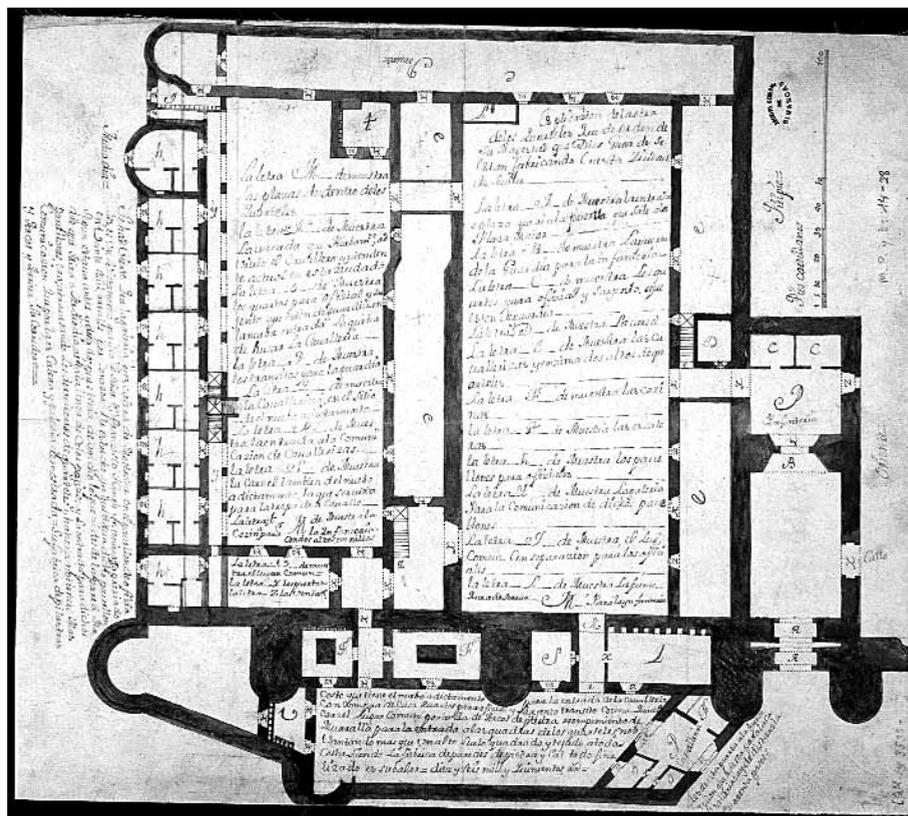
Abril 1749. Plano del alcázar, con galería para oficiales sobre el Rastro, una antemuralla hacia el Mercado Grande y una plaza de armas entre la muralla y el cuartel. AGS. MPD. 14-028
